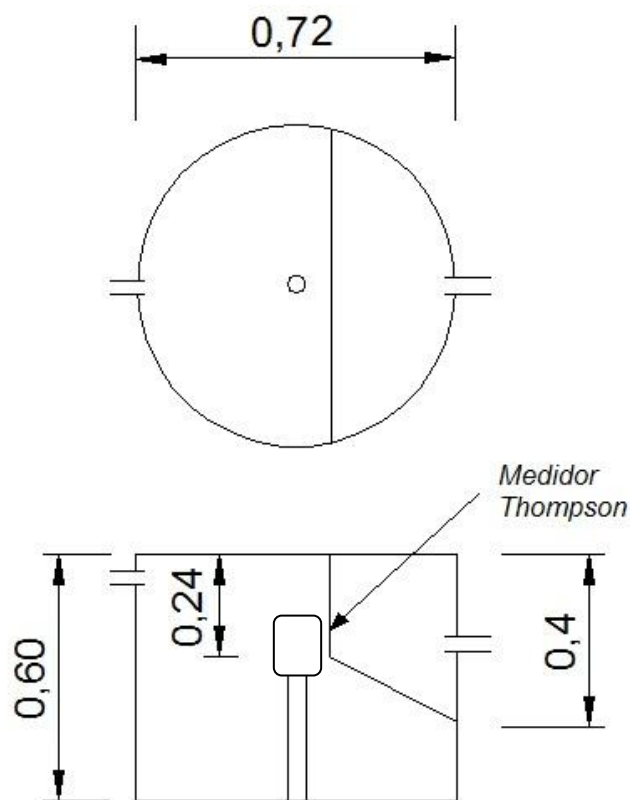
Corte e planta do Medidor Controlador de Vazão (medidas em metros)
